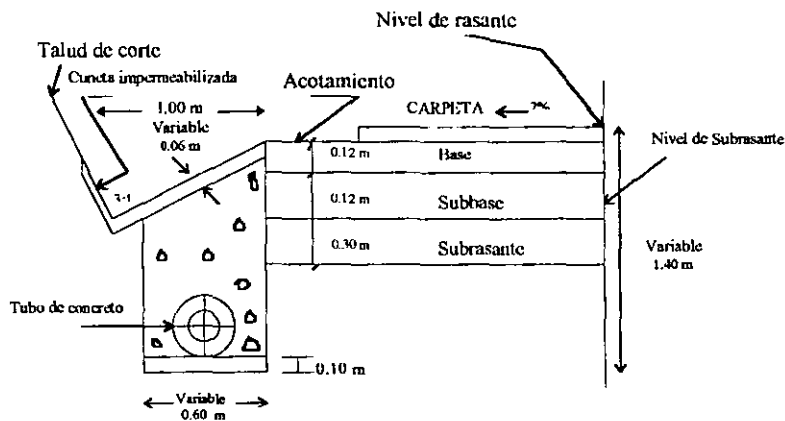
Detalle de la Sección Transversal del Drenaje
